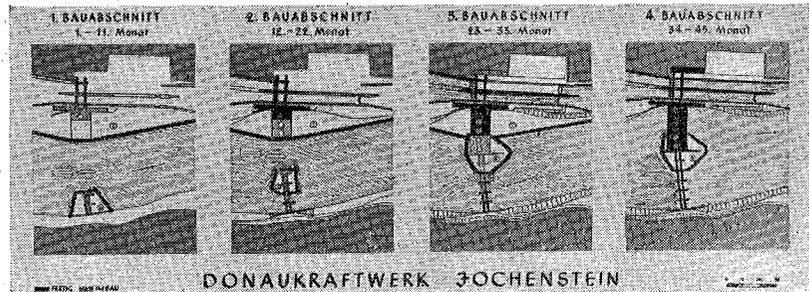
Geplanter Bauvorgang für die Donau-staustufe Jochenstein.
